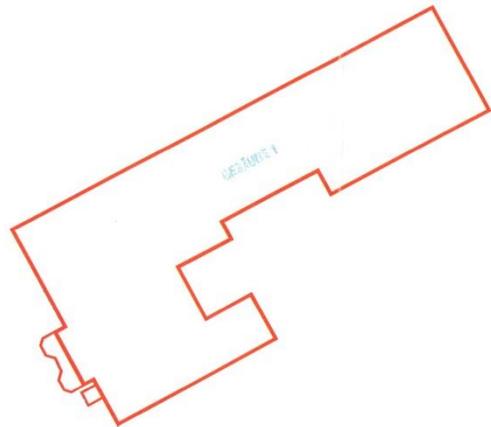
Grundriss Gebäude 1 (Quelle: Technisches Büro DI Bienert KG - Bestandsplan Gewerbepark)
